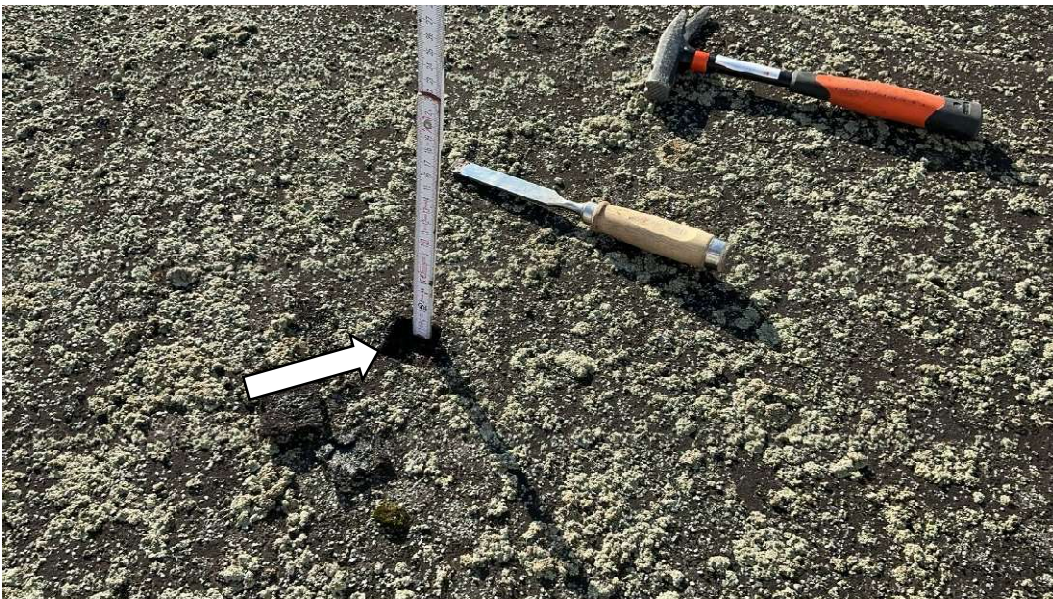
Ohne Asbest-/ KMF-/PAK - Befund: Abdichtungsbahn auf Betondach, vgl. P3
